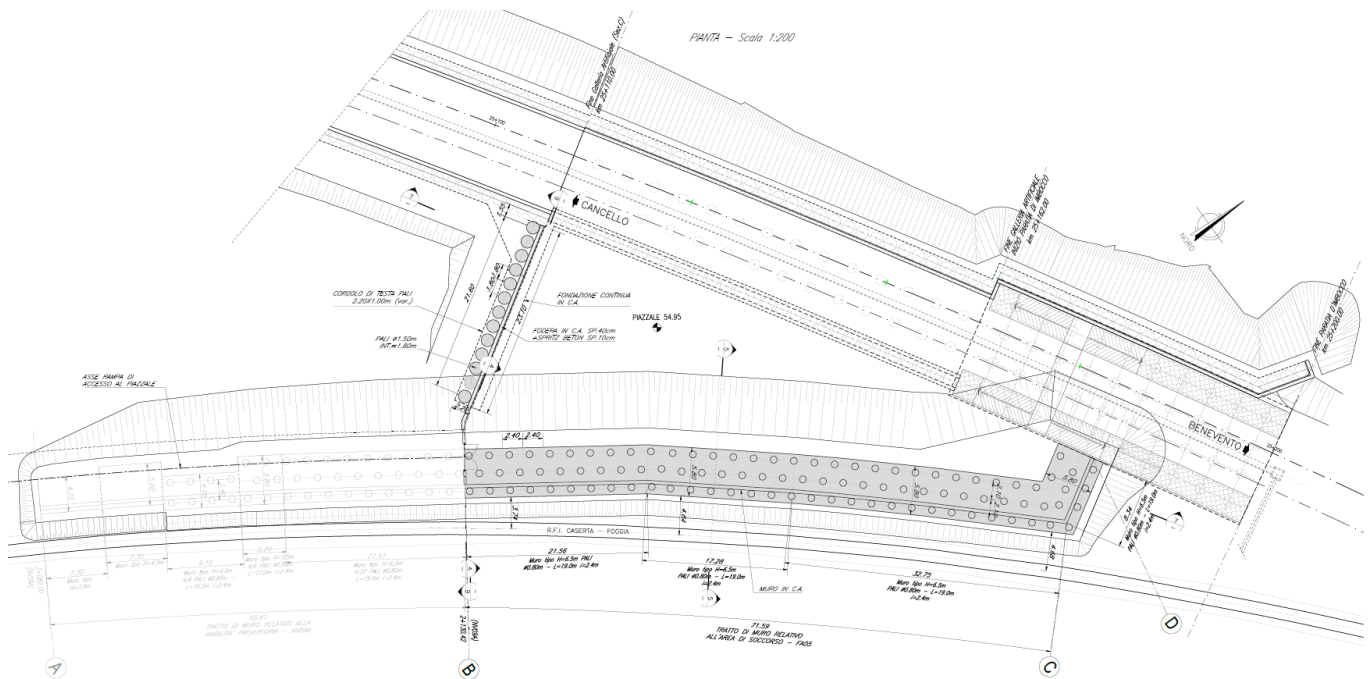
Progetto Esecutivo – Inquadramento planimetrico della paratia del piazzale FA05
